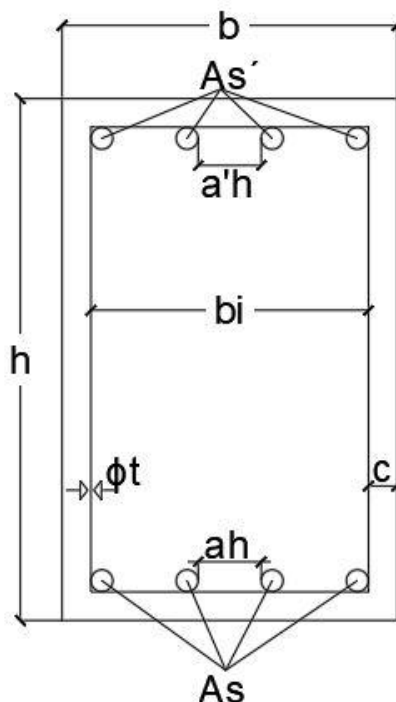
Espaçamentos horizontais na seção transversal da viga (Elaborado pela autora, 2018)
